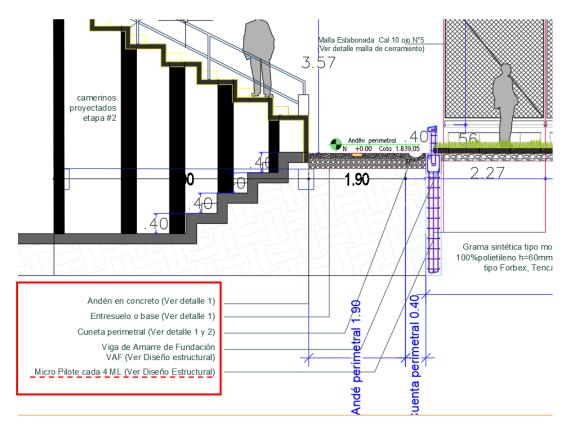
Pantallazo diseño micropilotes. Planimetría Arquitectónica – Secciones, corte transversal (zoom)
